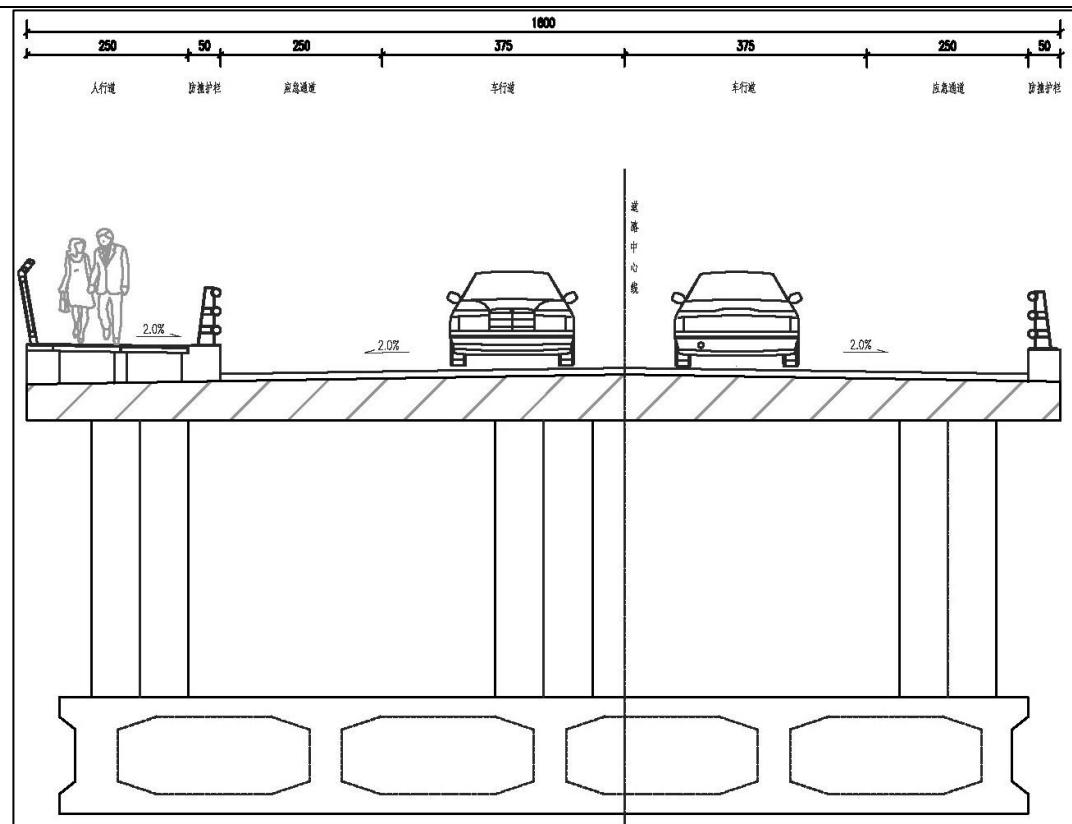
道路路基标准横断面图（白鹤 1 号桥）
